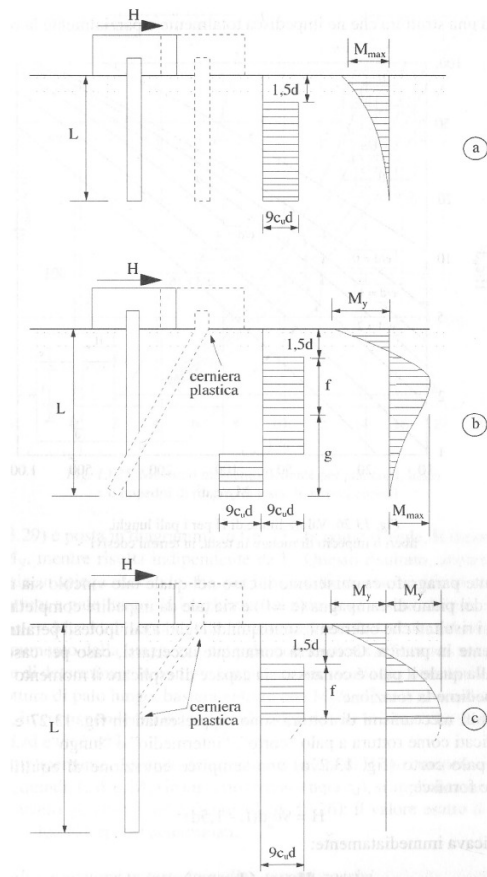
Rottura non drenata: possibili meccanismi di rottura.
